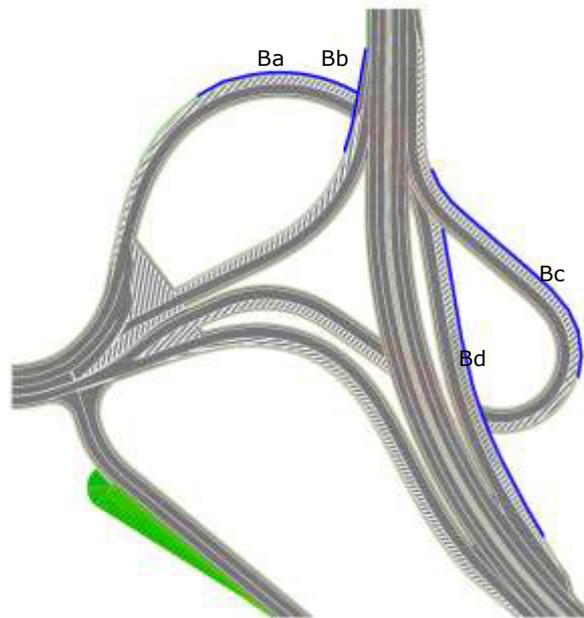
Barriere antirumore previste lungo le rampe di collegamento con la GVT
